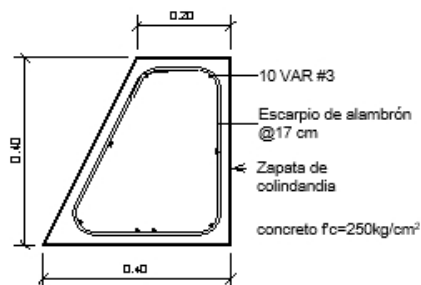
Detalle estructural de la zapata con sus especificaciones.
